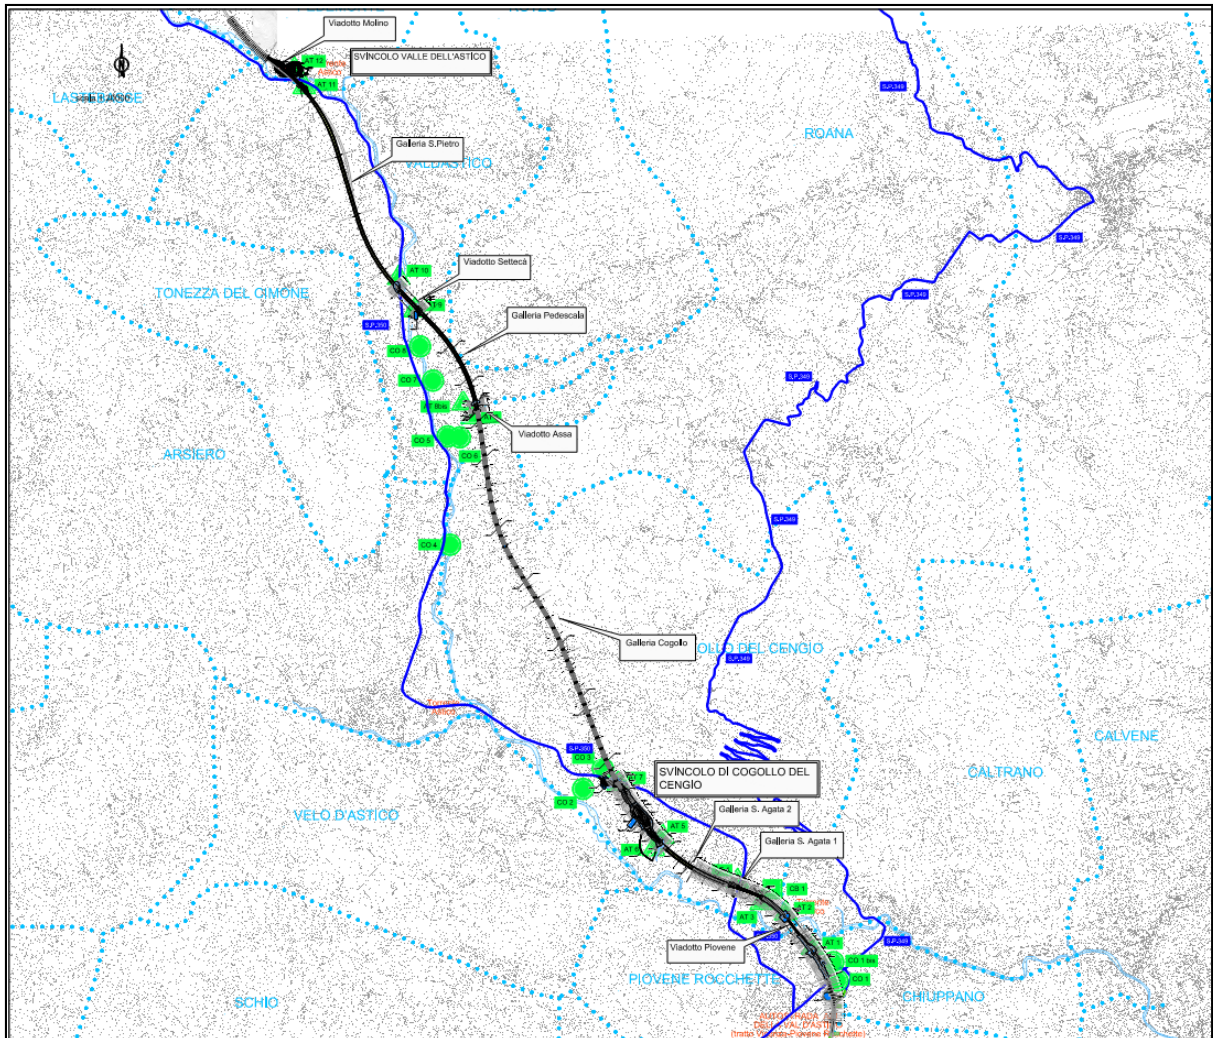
Localizzazione aree di cantiere lungo il tracciato del Lotto 1 della Valdastico
